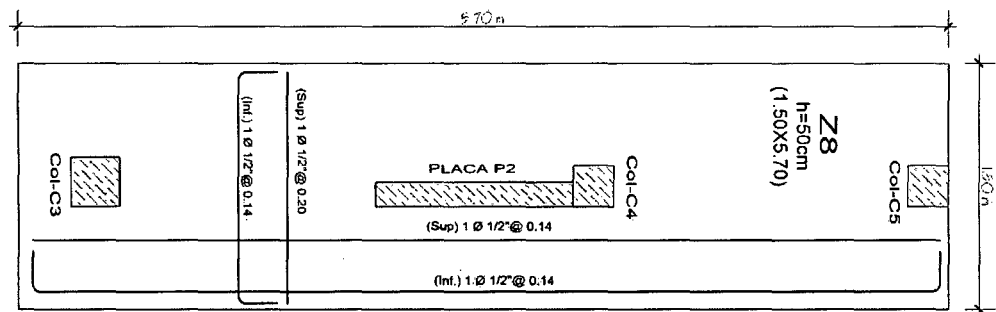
Distribución final del refuerzo para zapata Z-8.
